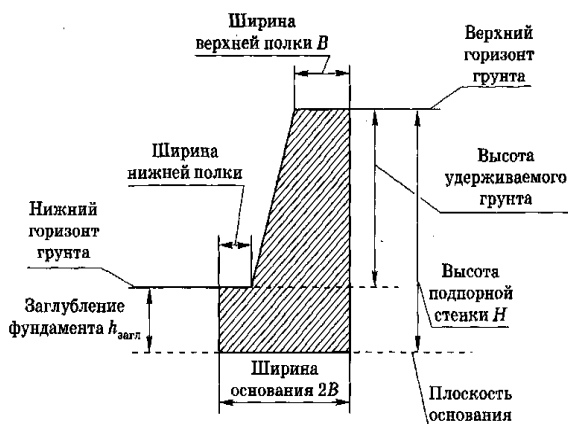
Схема конструкции подпорной стенки [36]
